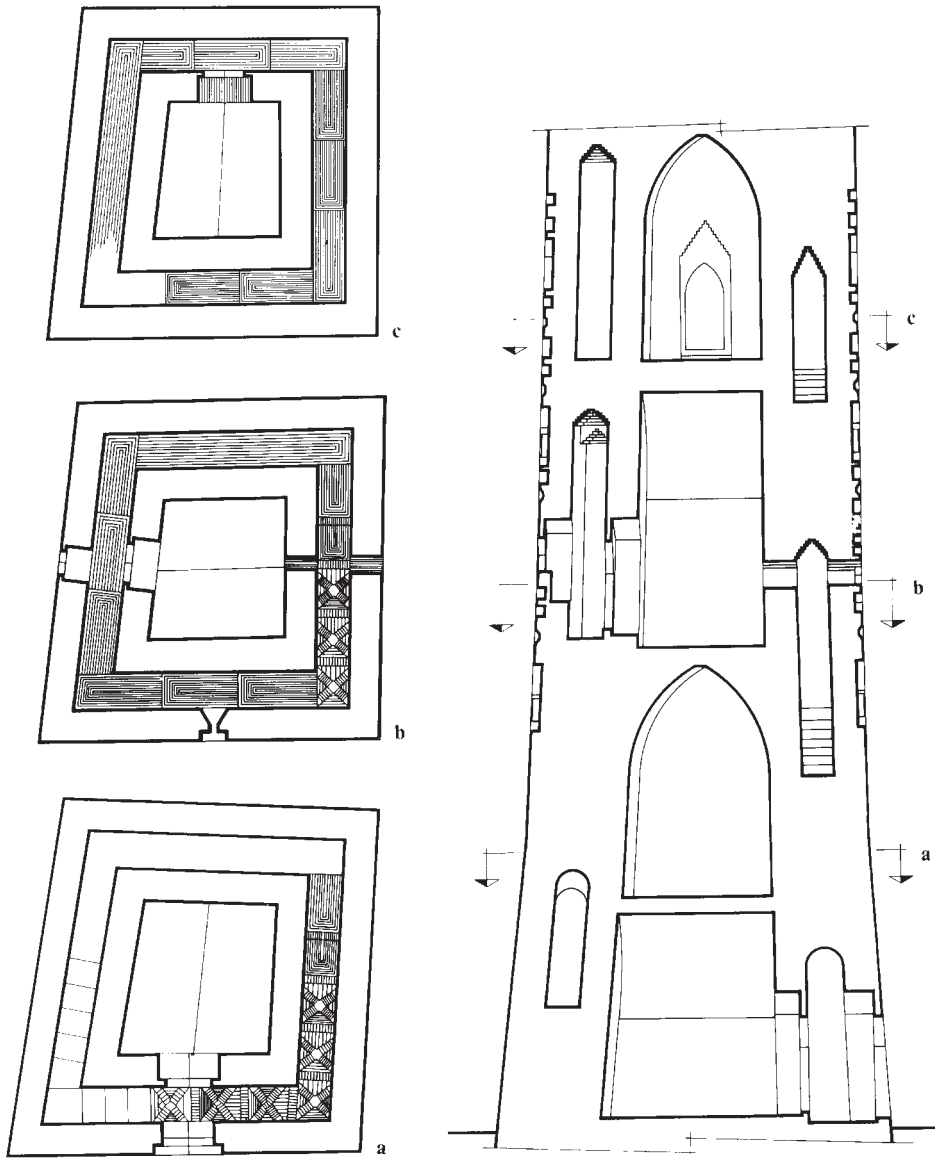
Torre de Santa María de Ateca. Plantas y sección.
